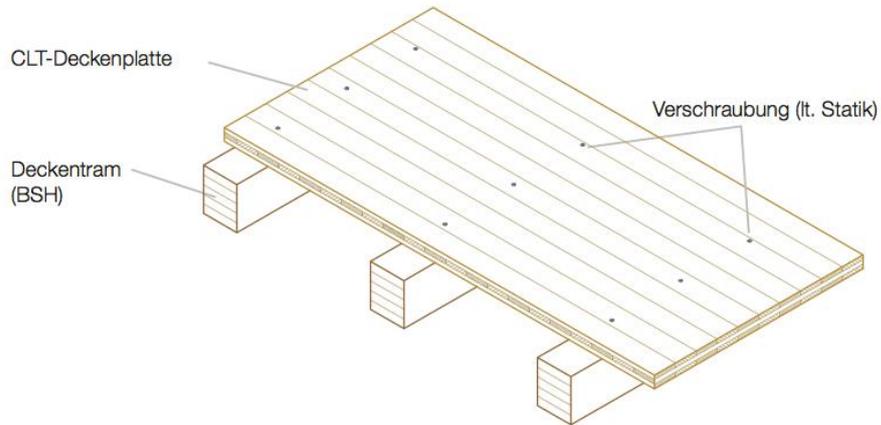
Tramdecke - Storaenso¹⁸⁸
